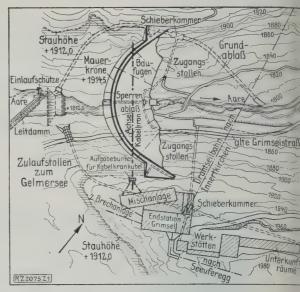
Lageplan der Spitallammsperre und der Bauanlagen auf dem Nollen.
